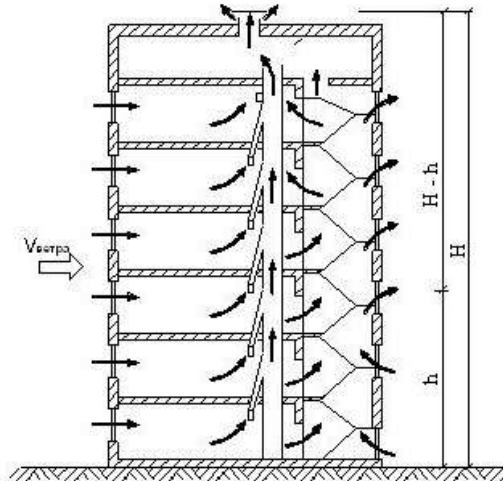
Формирование воздушных потоков в многоэтажном здании со сбалансированной механической вентиляцией
